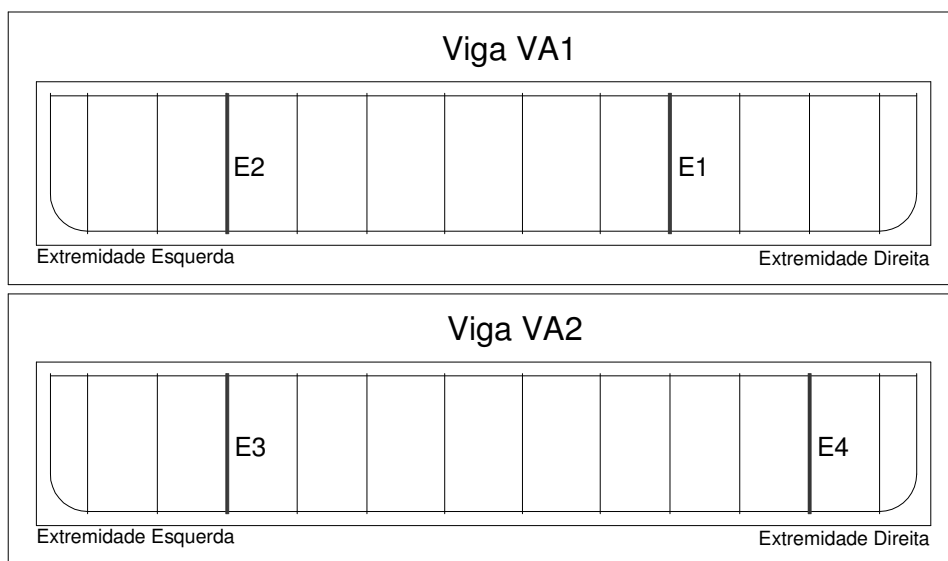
Localização dos estribos monitorados nas vigas VA1 e VA2 (vista frontal ou face de referência)
